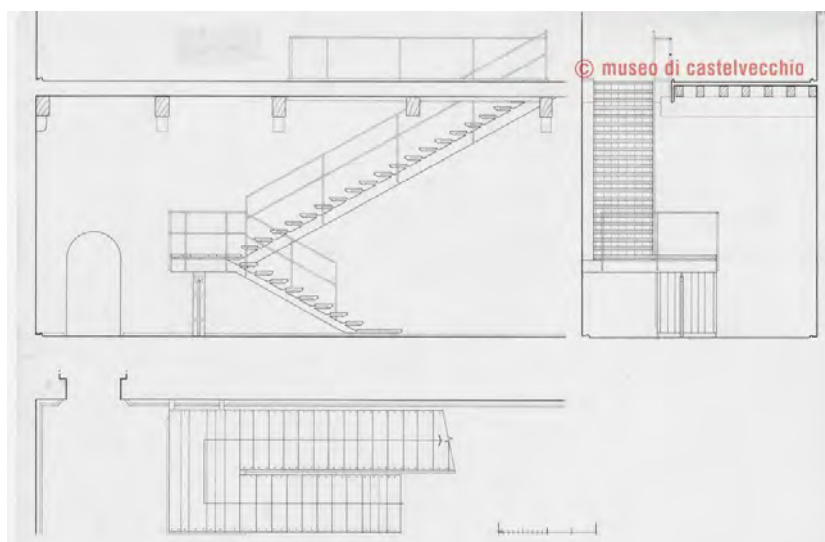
Rilievo in pianta, prospetto laterale e frontale della scala tra il primo e il secondo piano della Reggia.
